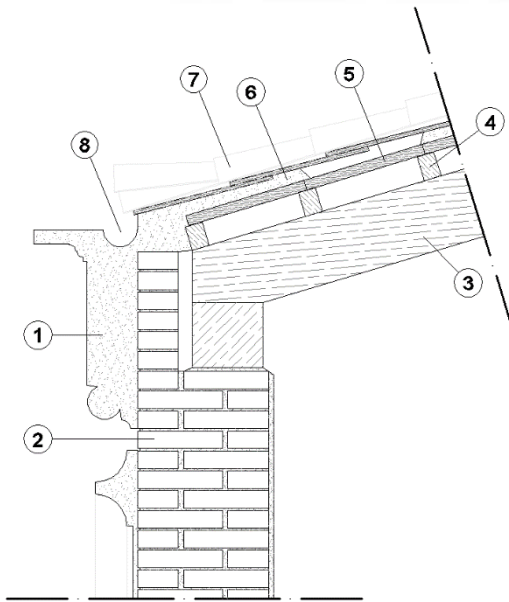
Detalle de cubierta de fachada del edificio. Fuente propia.
